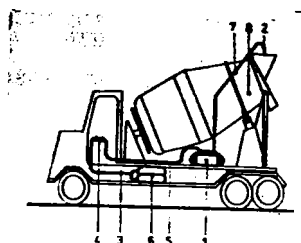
Schema instalației de dozare a superplastifiantilor de pe autobetoniere.
